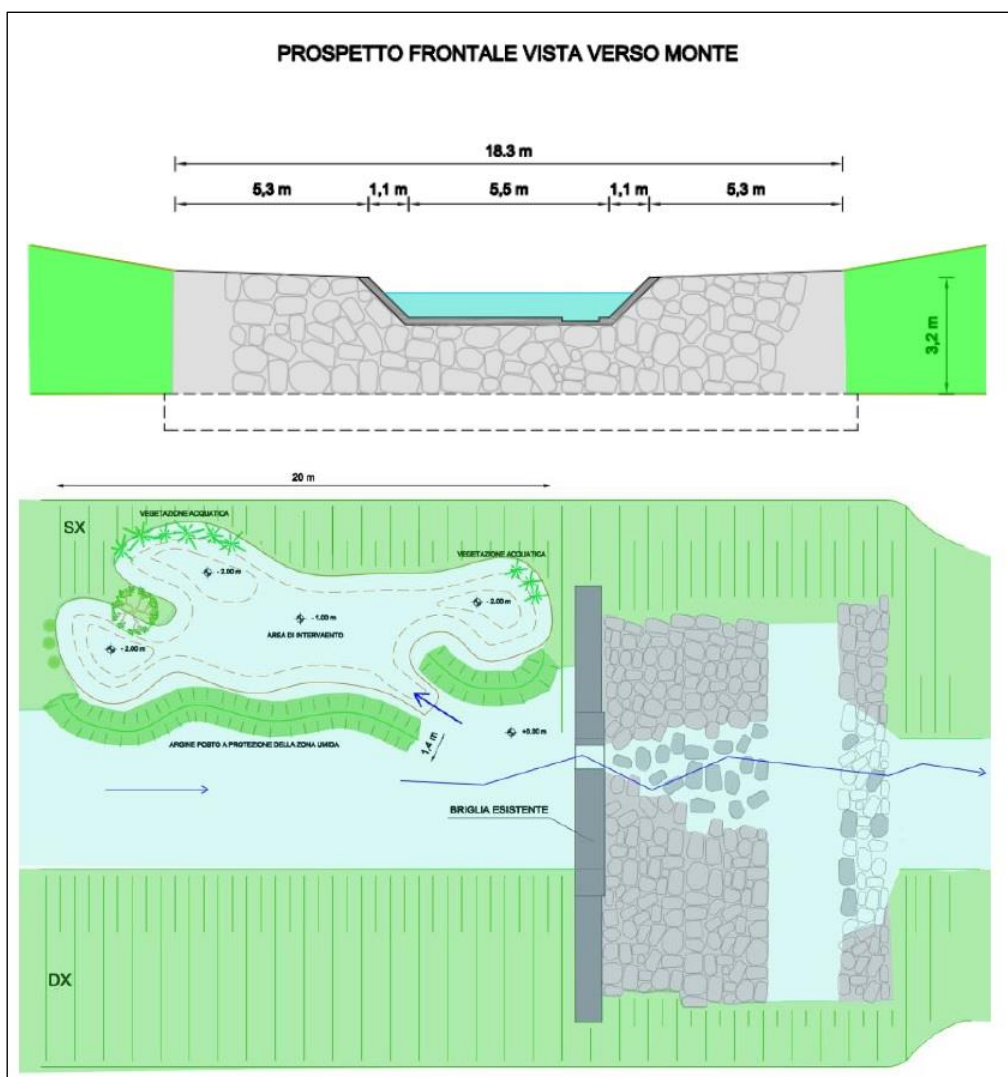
Schema di progetto della rampa realizzata lungo il Rio Lavezza. A monte della rampa esistente è stata realizzata un'area umida connessa all'alveo del rio.
